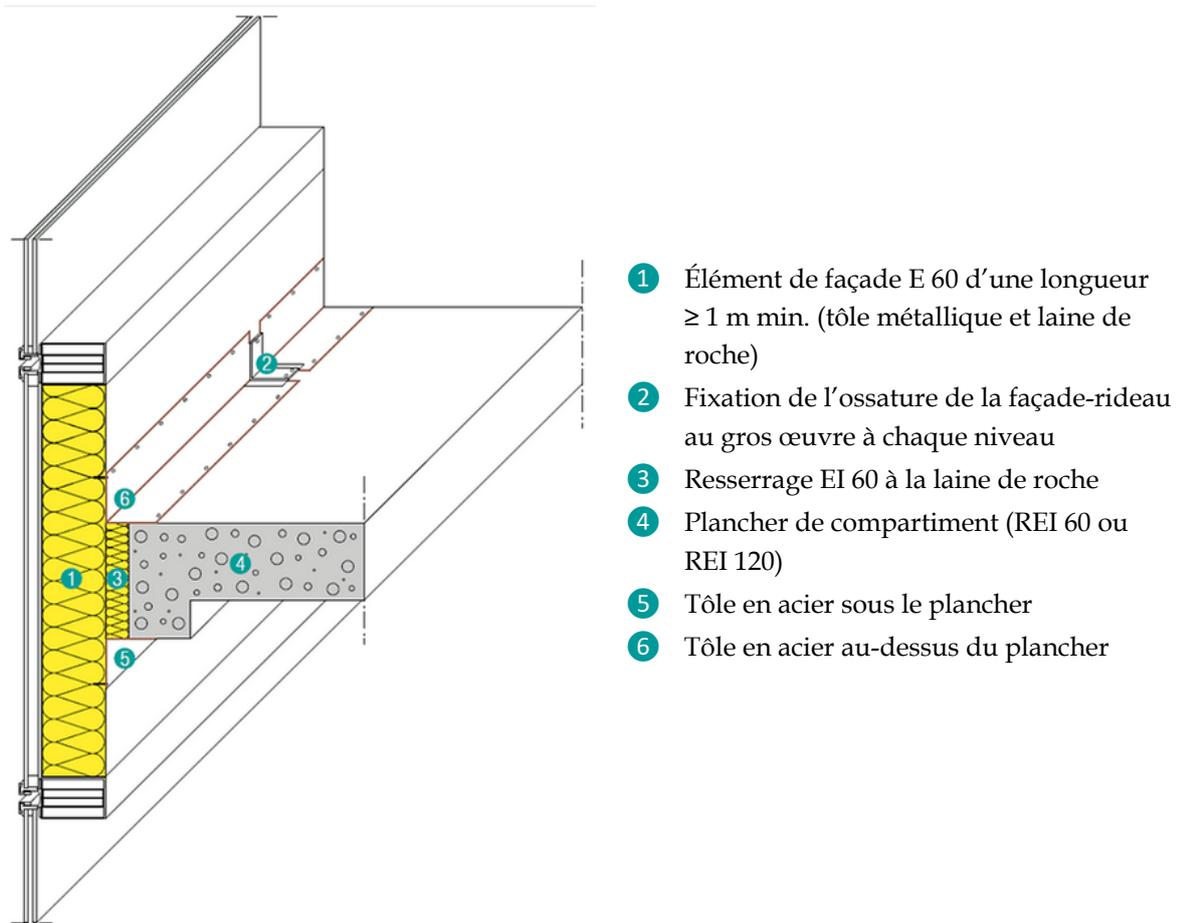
Exemple d'élément étanche au feu E 60 et de sa liaison à un plancher en béton dans le cas d'une façade-rideau.
